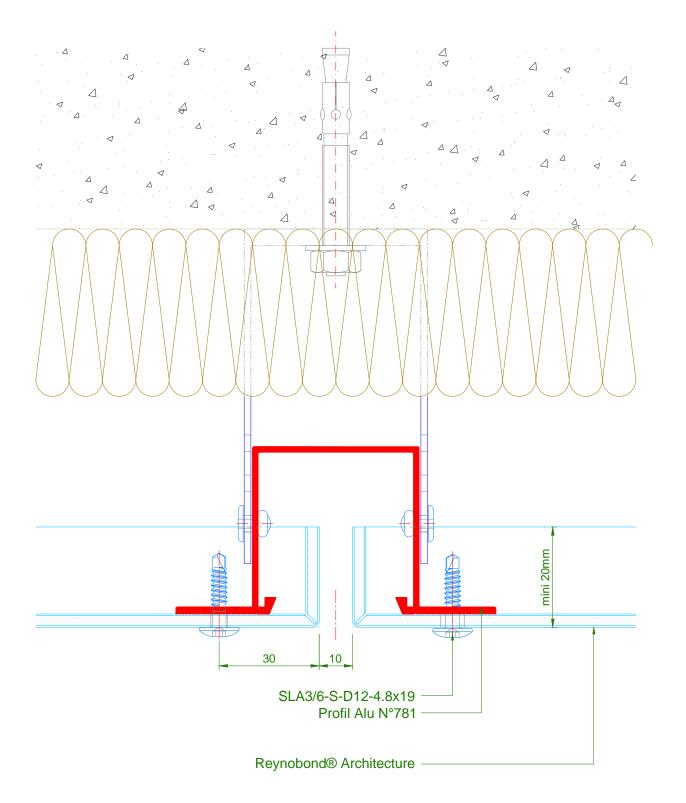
uater – Joint vertical - Coupe horizontale – Système vissé SC 50 2c - Avec plis de renfort
